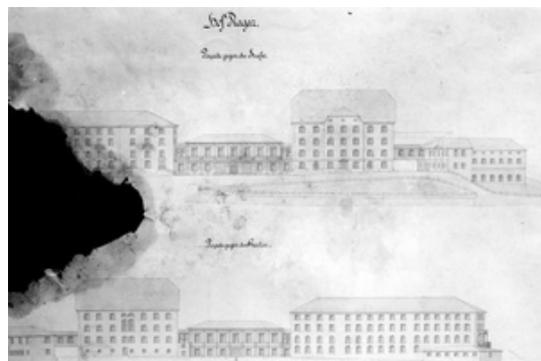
Hof Ragaz, Plan 54, Fassaden gegen Strasse/Garten, 1867
